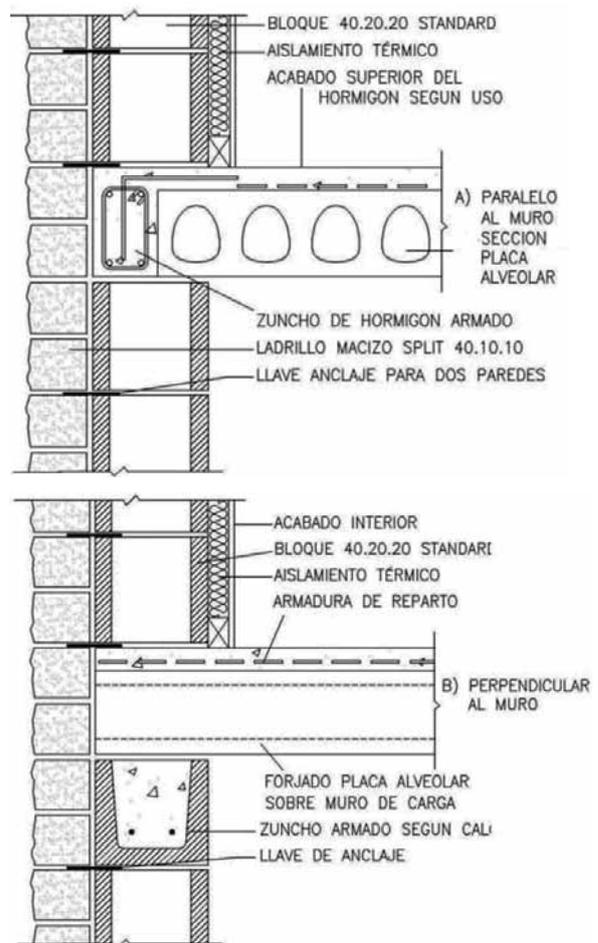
Secciones de encuentro de muro doble de ladrillo y bloque hueco con forjado de placas alveolares cargando en la hoja interior del cerramiento.
